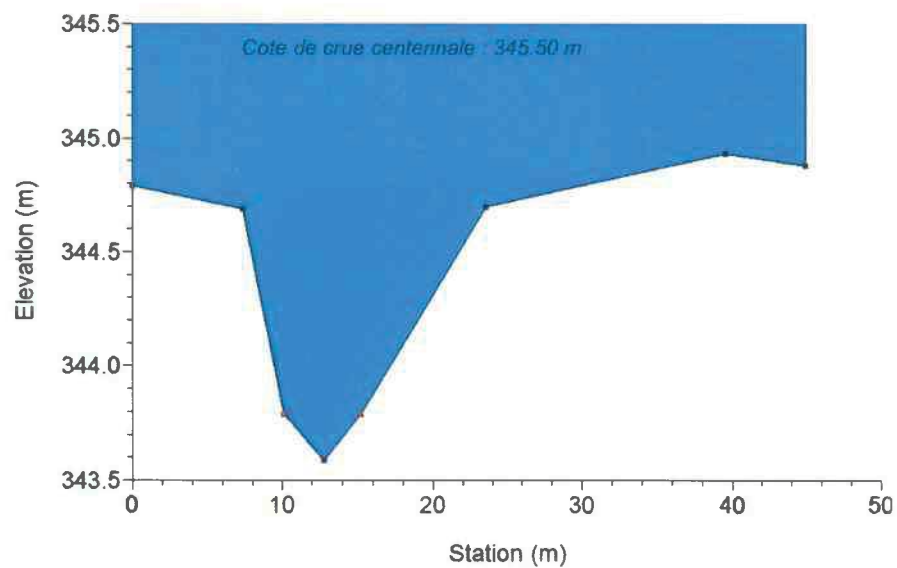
Profil en travers P1 - sortie de l'ouvrage cadre
